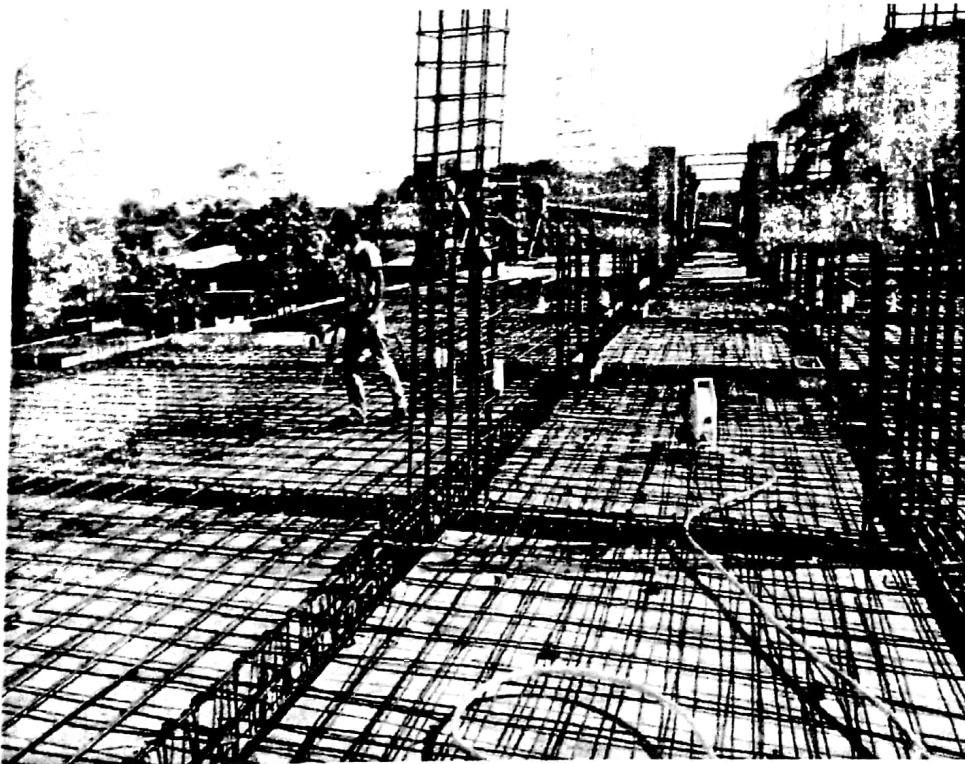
Baja tulangan sebagai perkuatan pada struktur beton	1
